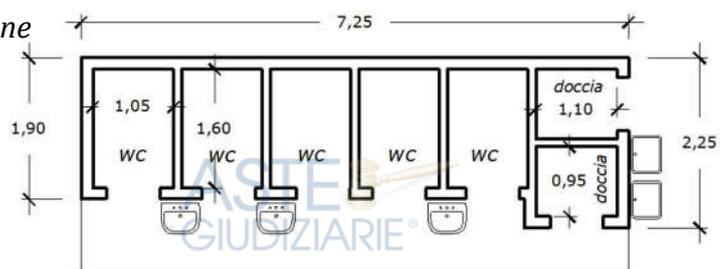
Il blocco servizi composto da 5 cabine wc e 2 cabine doccia (rif.n.7 nella planimetria catastale agli atti - rif.n.15 nella planimetria di progetto a pag.22)
